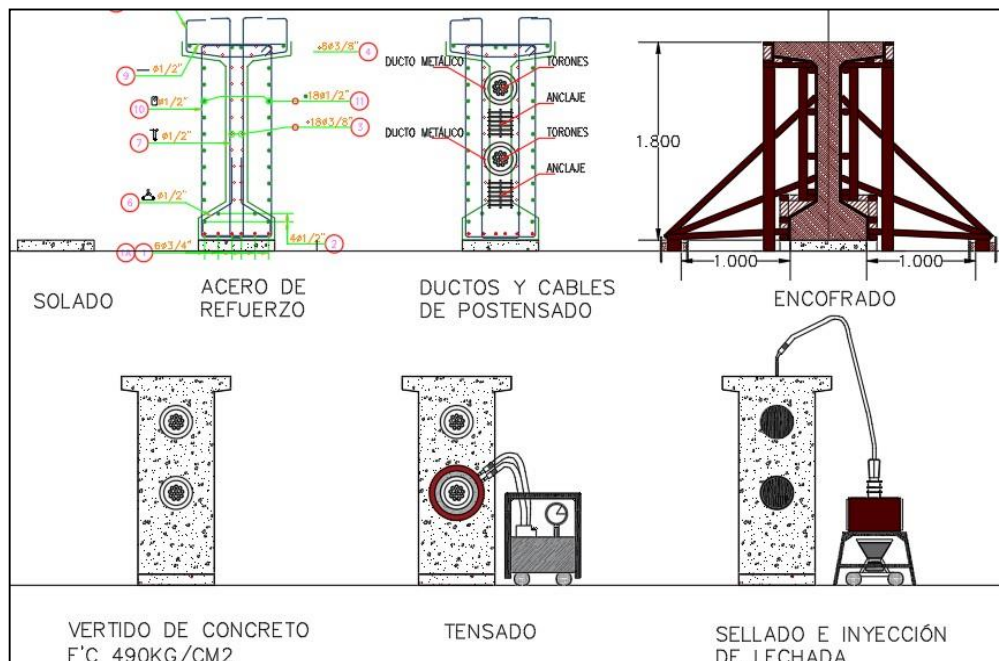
Proceso constructivo de una viga de concreto de postensado
